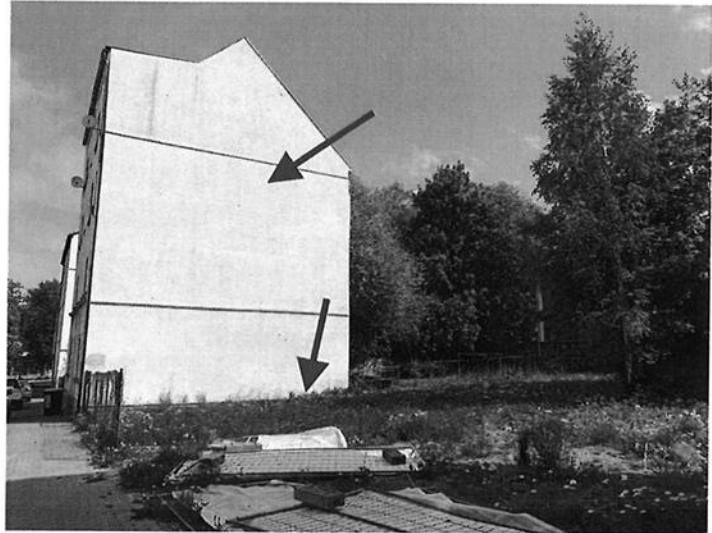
Ansicht Giebelwand Gebäude Kantstraße 5 und im Norden angrenzendes unbebautes Grundstück Flnr. 246 b
